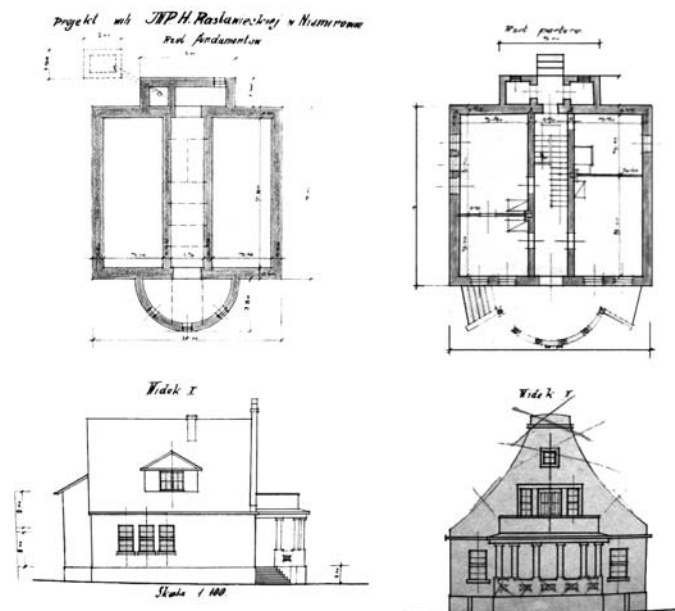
Проект мурованої вілли Г. Раславецької в Немирові. План фундаментів, партеру та фасадів [25, арк. 2].
